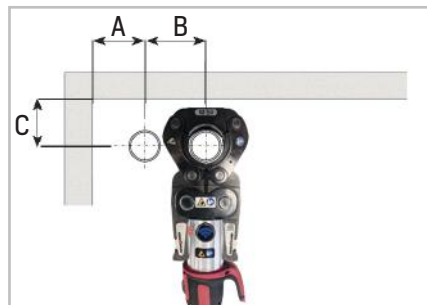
Mindesteinbaumasse für Pressschlinge /- Kette
